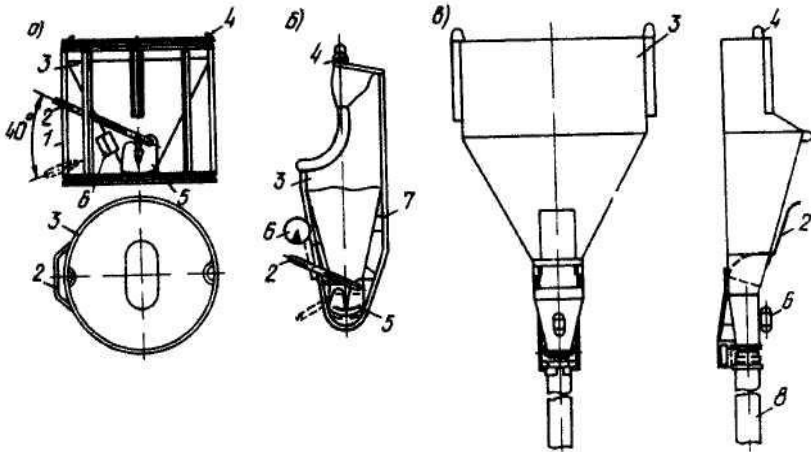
Типы бадей (бункеров) для приёма и подачи бетонной смеси:
